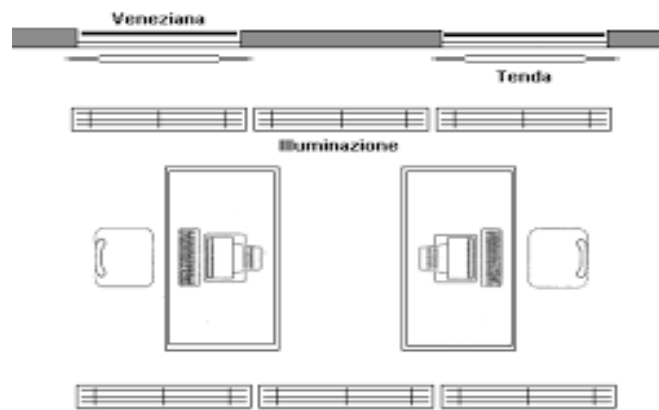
la disposizione della postazione di lavoro rispetto alle fonti di luce.
